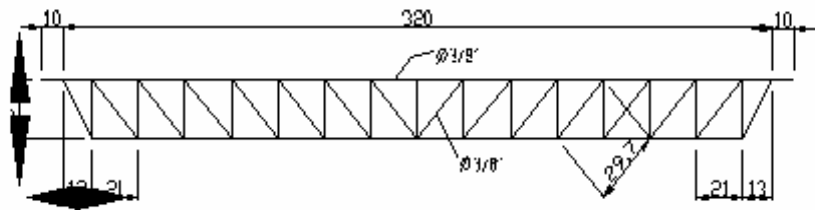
Vista lateral vigueta metálica (Configuración Pratt).
